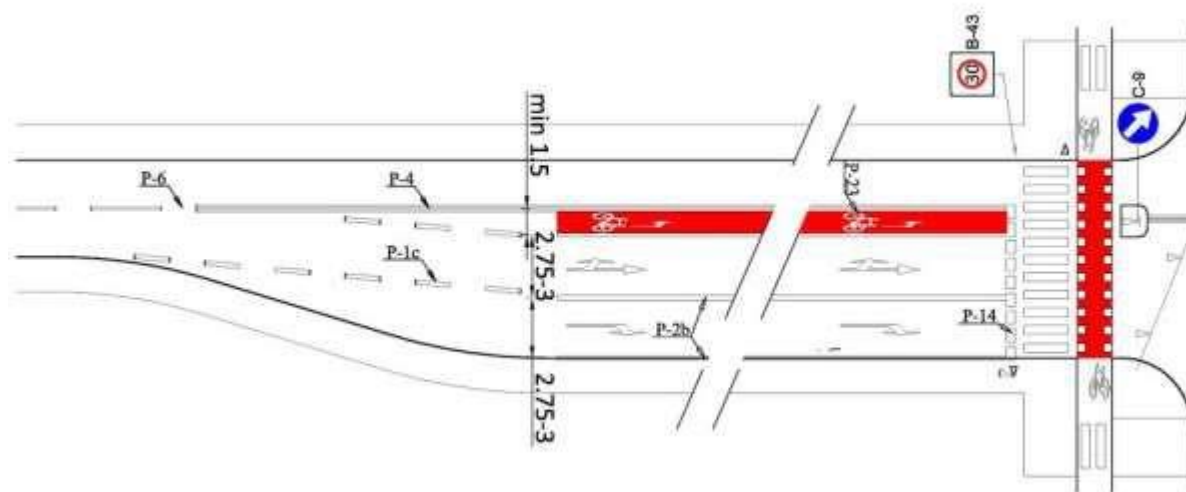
Przykład azylu w ramach przejazdu dla rowerzystów i przejścia dla pieszych
